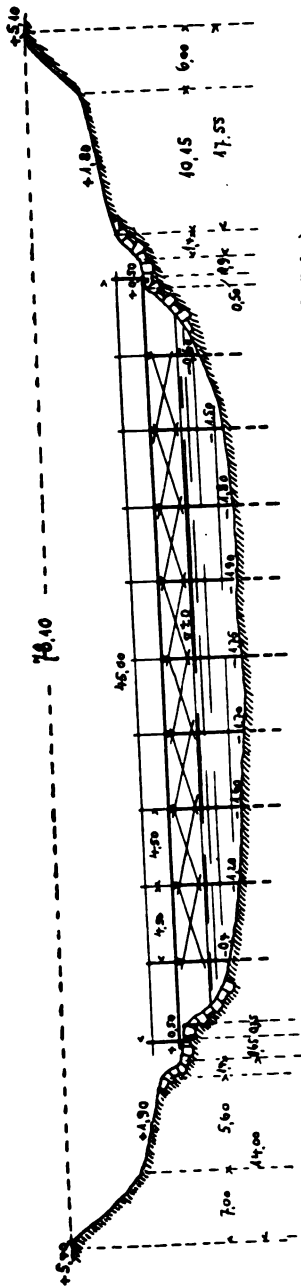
Zum Umbau bestimmte vorhandene Pfahljochbrücke (Kolonnenbrücke).
